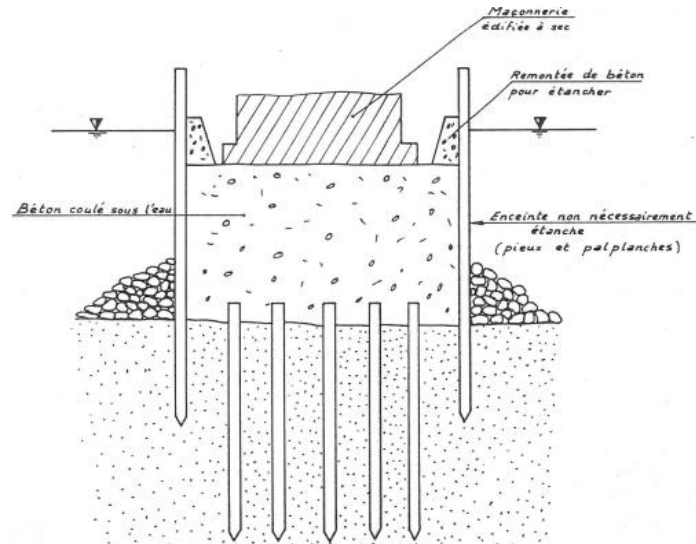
Fondation sur pieux et plate-forme en béton (Levillain, 1980)
